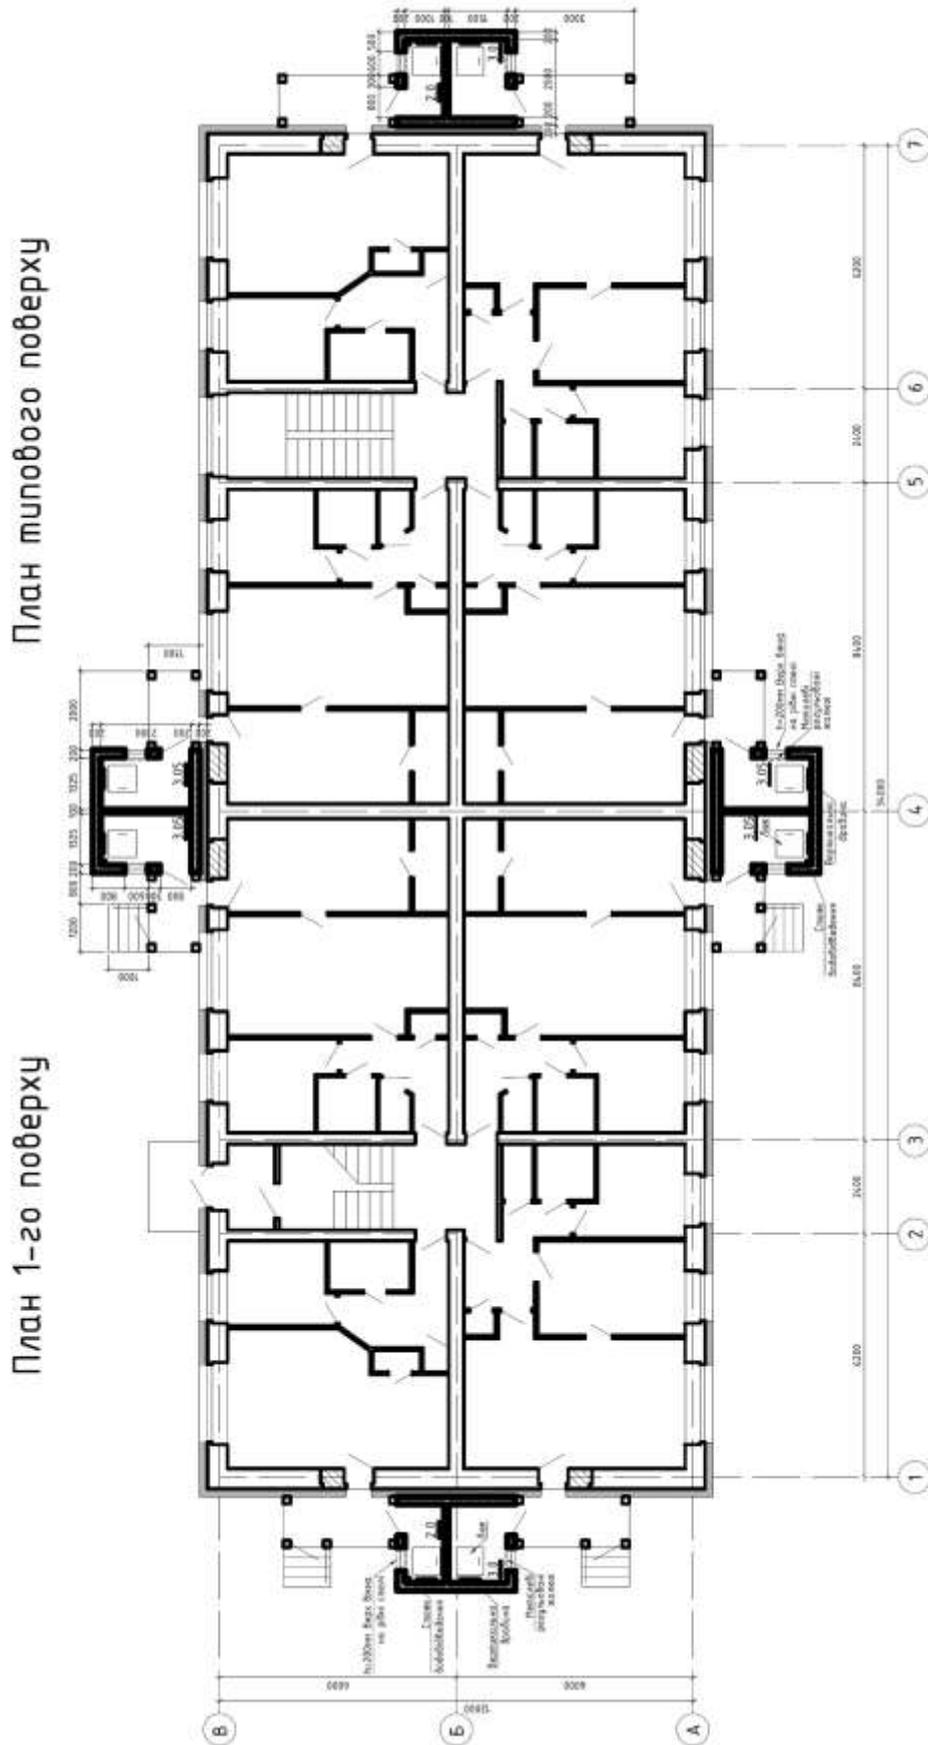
Схема планів першого та типового поверхів житлового п'ятиповерхового будинку, проектна пропозиція.
